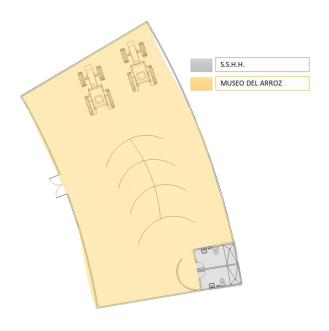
Plano Arquitectónico, Museo del Arroz
